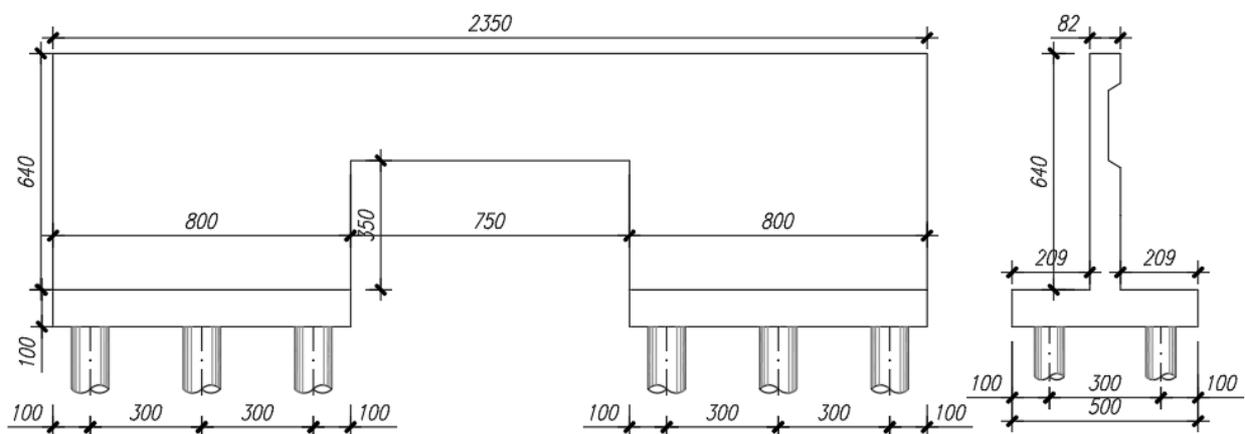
Prospetto e sezione portale di scavalco L=7.50m
